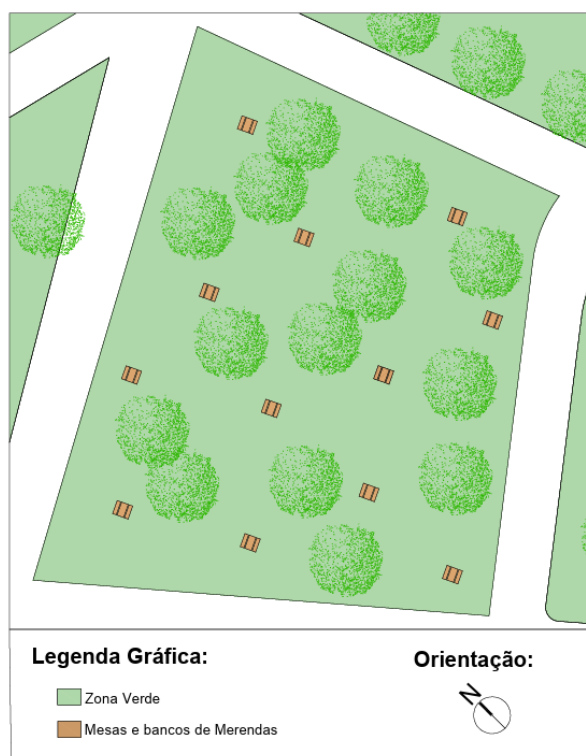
Planta de Pormenor do Parque de Merendas.
